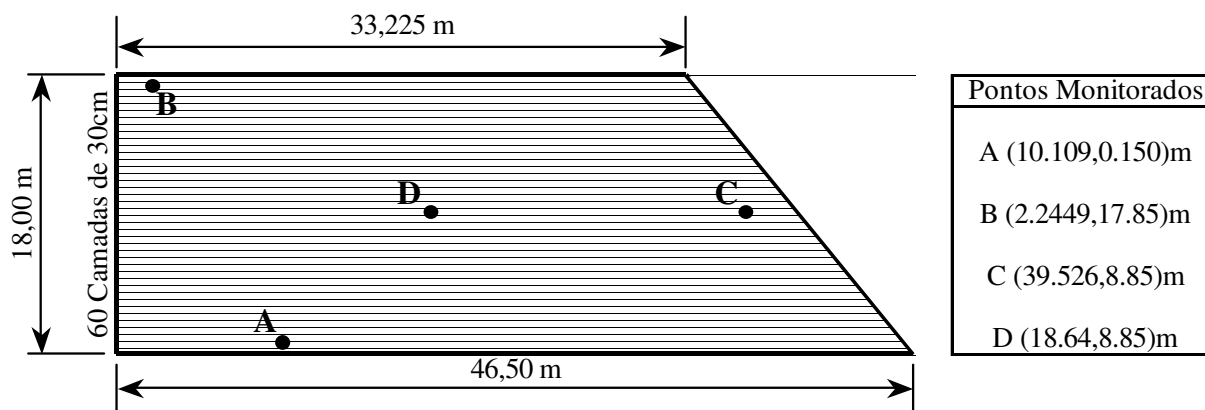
Layout da barragem e Posição dos pontos monitorados
